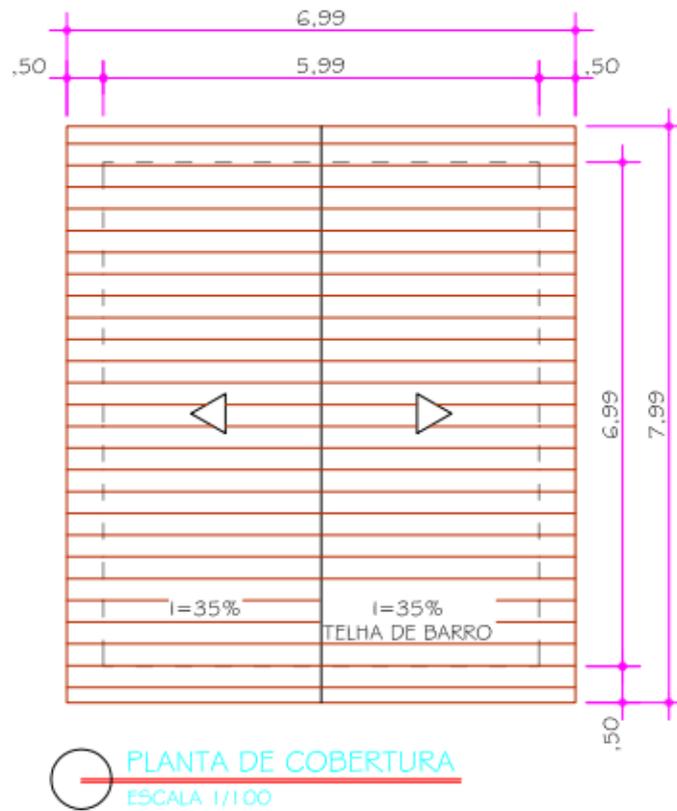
Planta de cobertura da casa (GIDUR, 2007).
